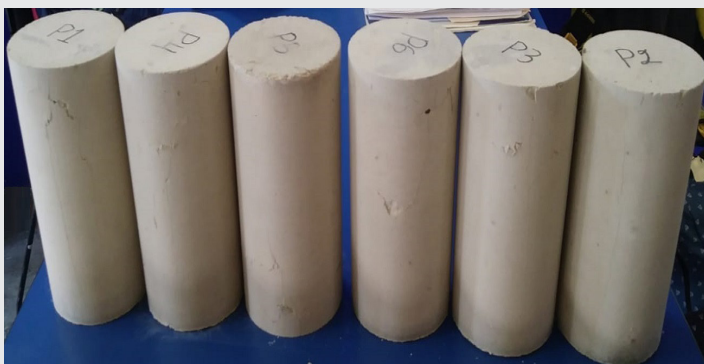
Probetas cilíndricas después del ensayo de compresión uniaxial.
